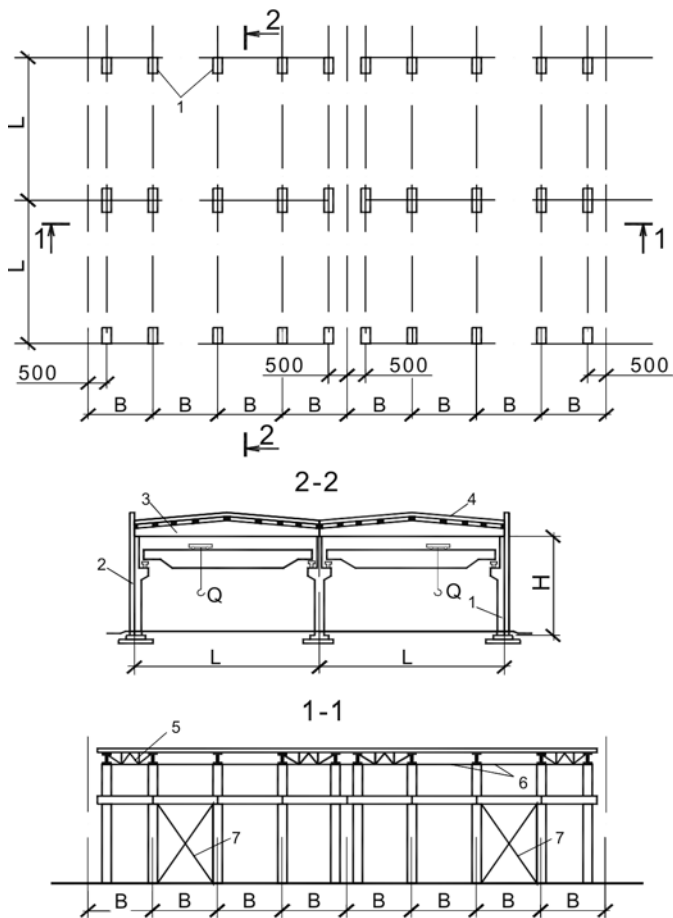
Конструктивная схема одноэтажного производственного здания: 1 – колонна; 2 – стена; 3 – ригель рамы; 4 – покрытие; 5 – вертикальные связи по фермам; 6 – распорки; 7 – вертикальные связи по колоннам
